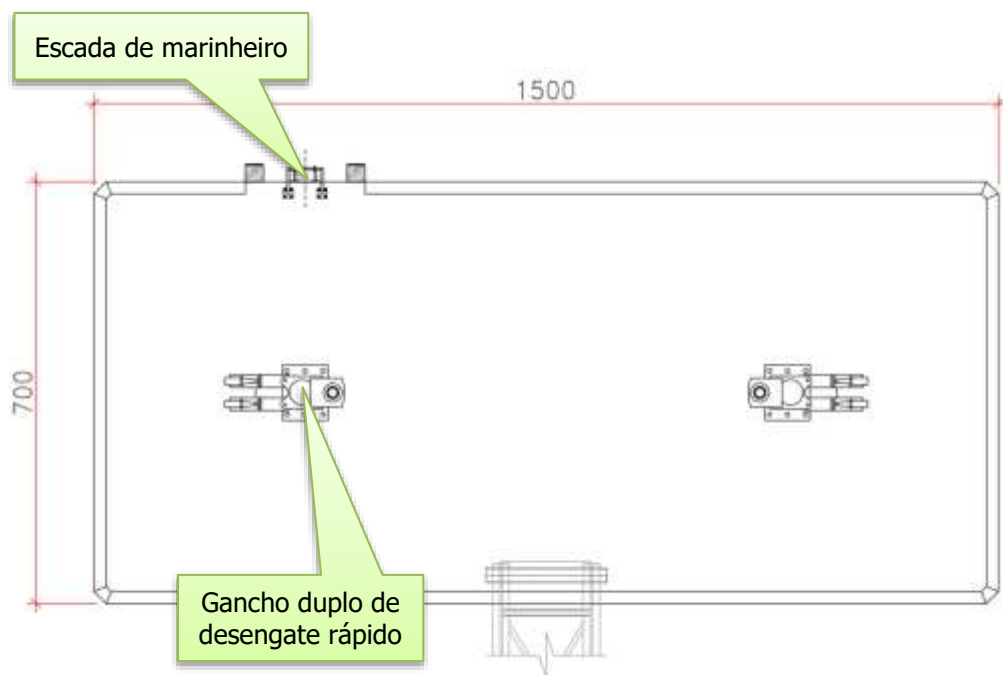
Delfim de amarração (DAM-01) – Arranjo geral
